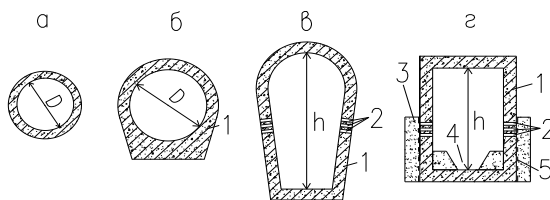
Формы поперечного сечения дренажных труб и галерей из бетона и железобетона
